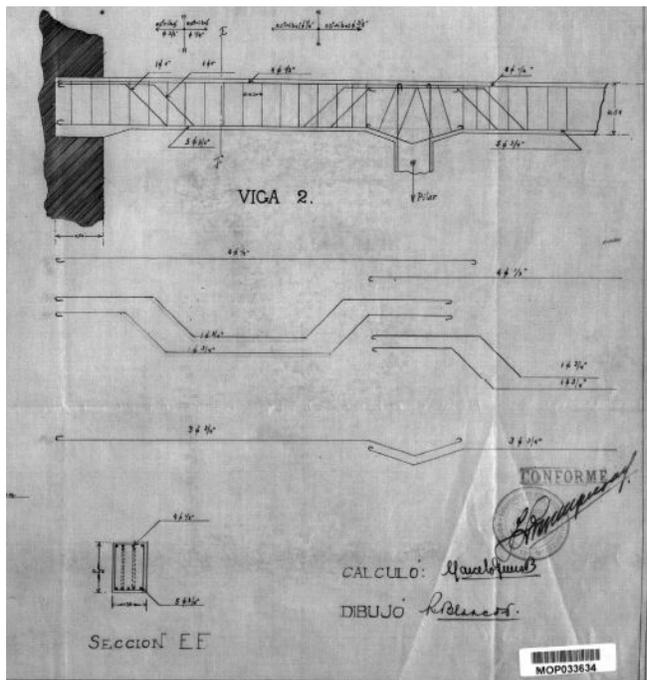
Planimetría vigas sistema Wayss Edificio ex Congreso Nacional. Fuente: Archivo DEPA MOP
